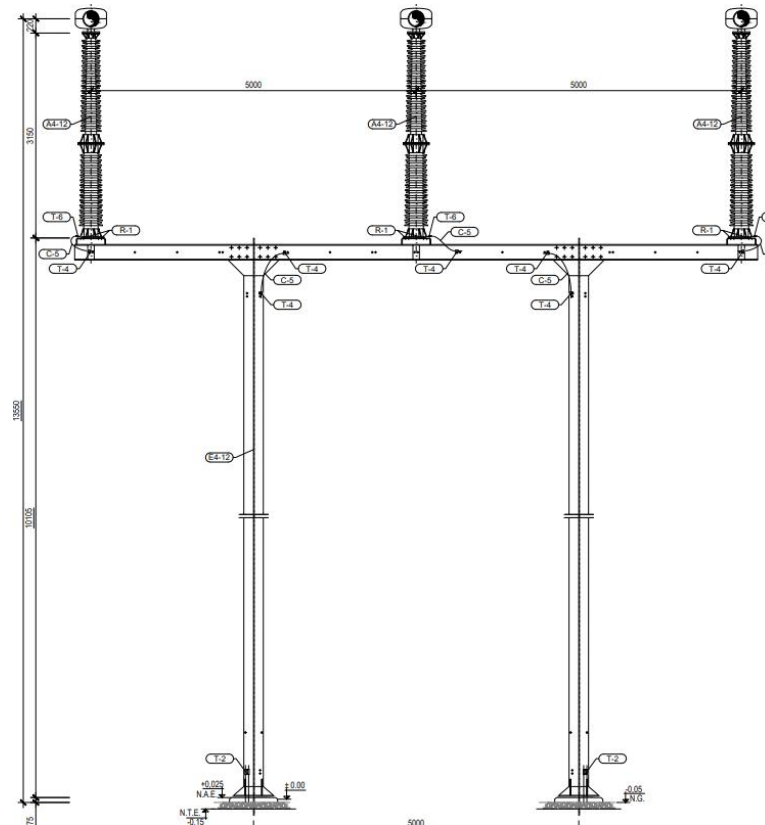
Aisladores sobre el pórtico de 400 kV,
